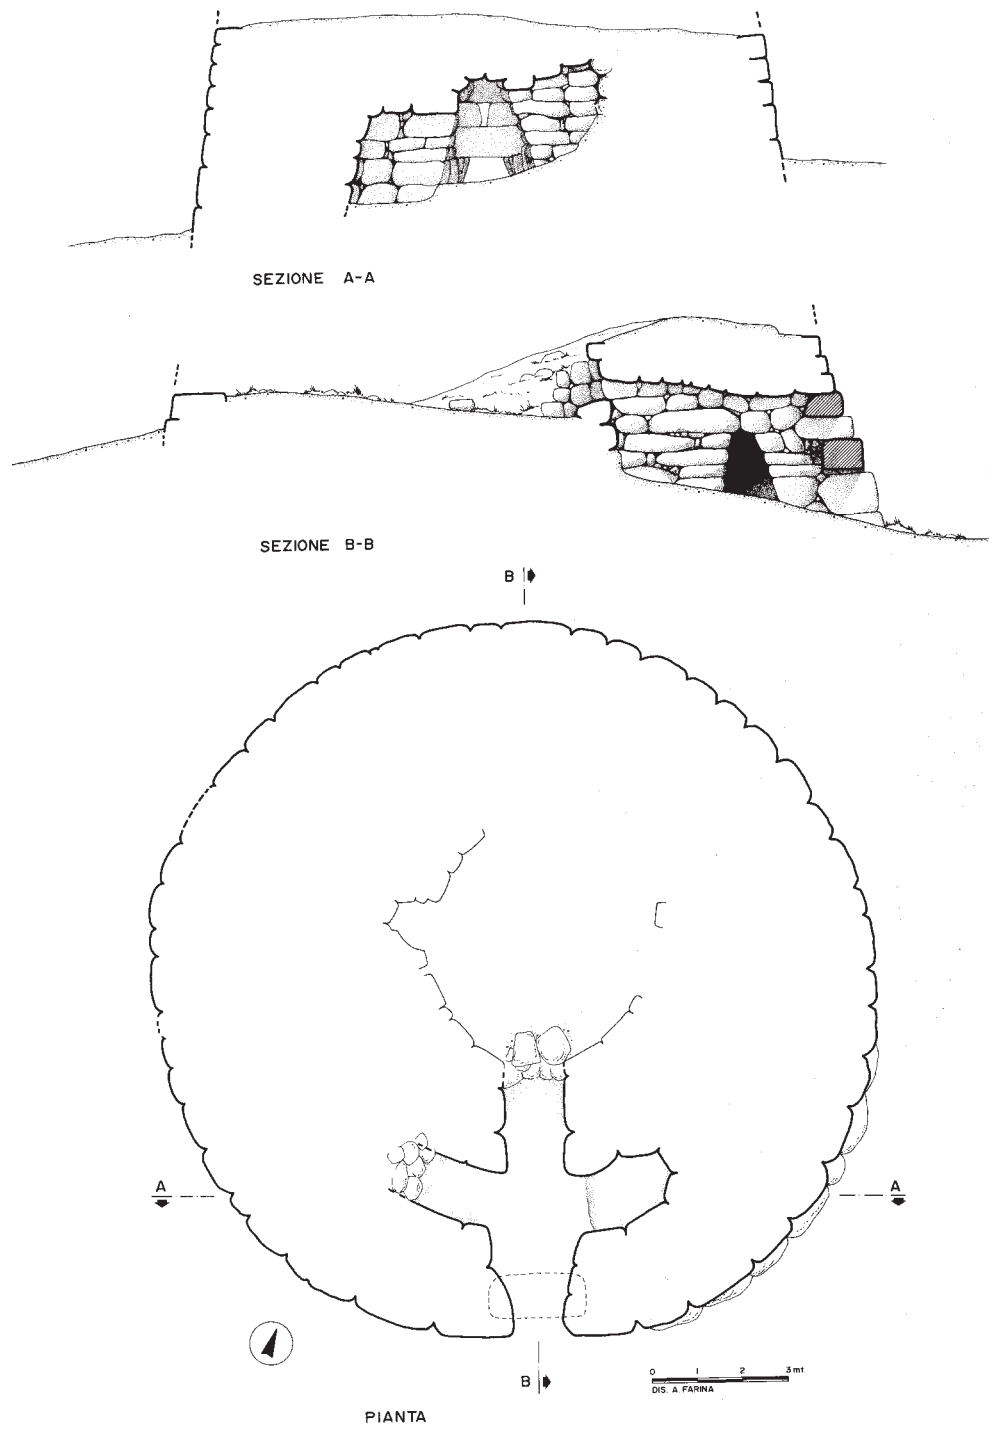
Noragugume, Nuraghe Murasune: pianta e sezione.
